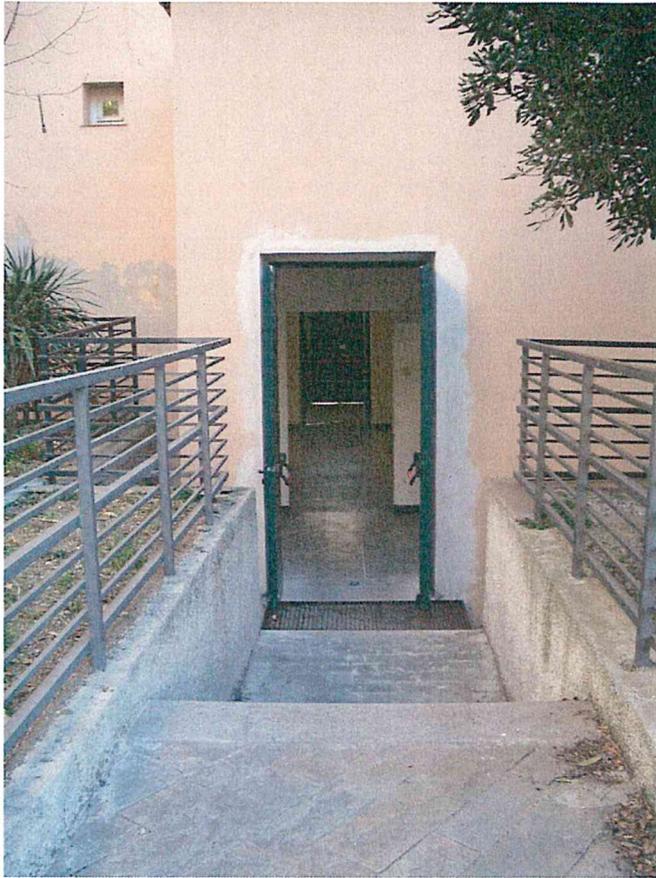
Particolare Prospetto Sud: portone di ingresso alla scuola/uscita di sicurezza
